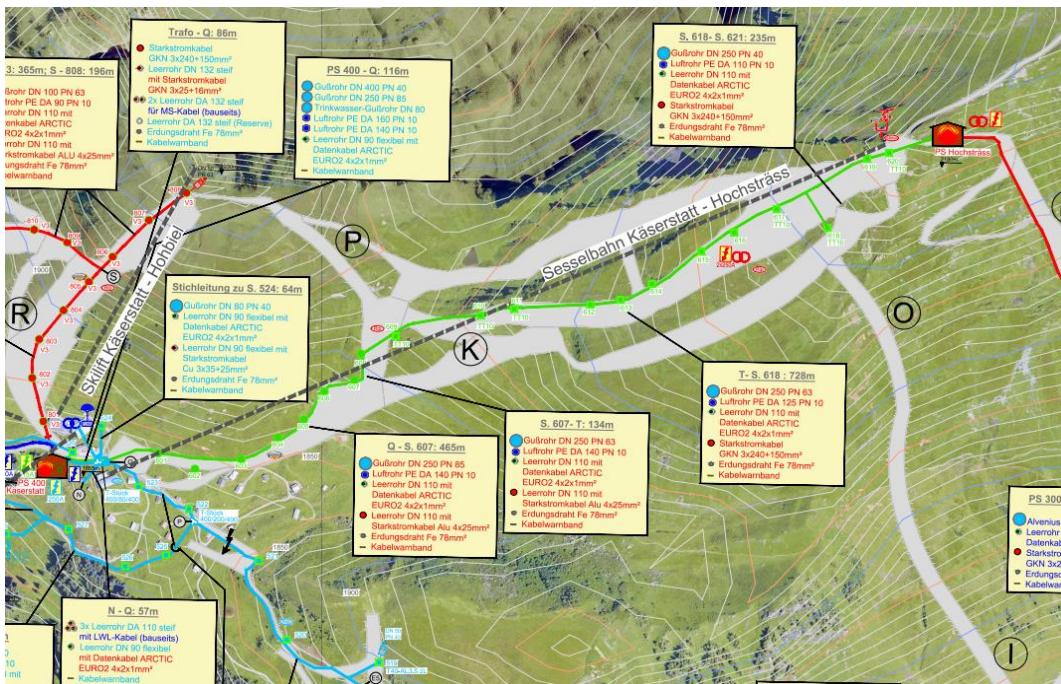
Planausschnitt Beschneiungsanlage des gesonderten Bauvorhabens
